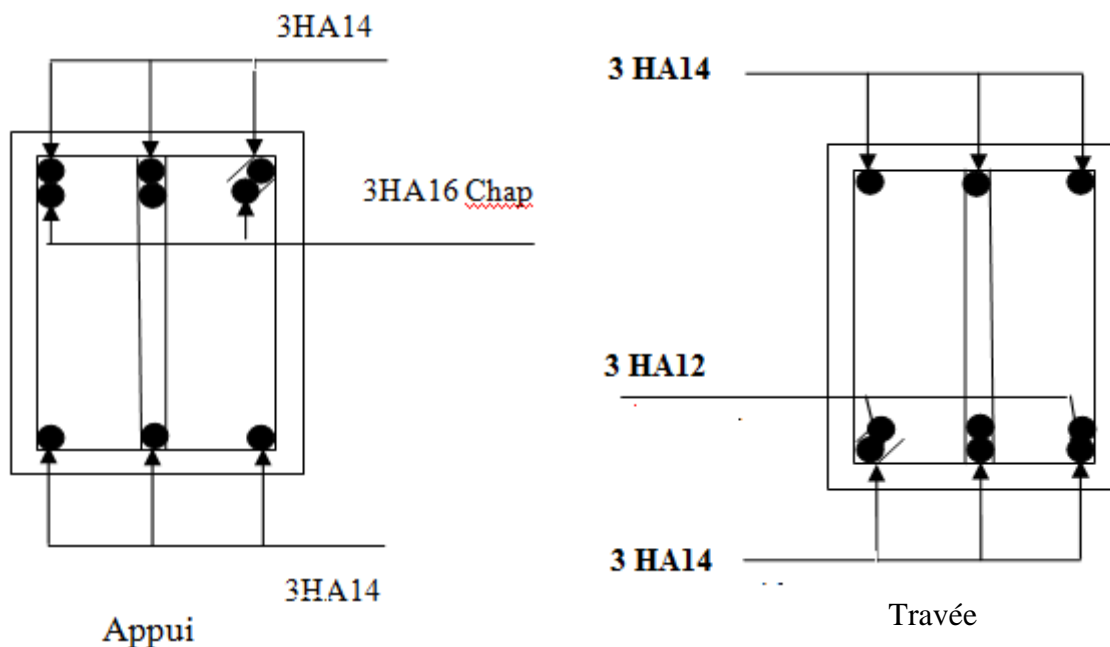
Schéma de ferrailage des poutres principales pour le s.sol et RDC
